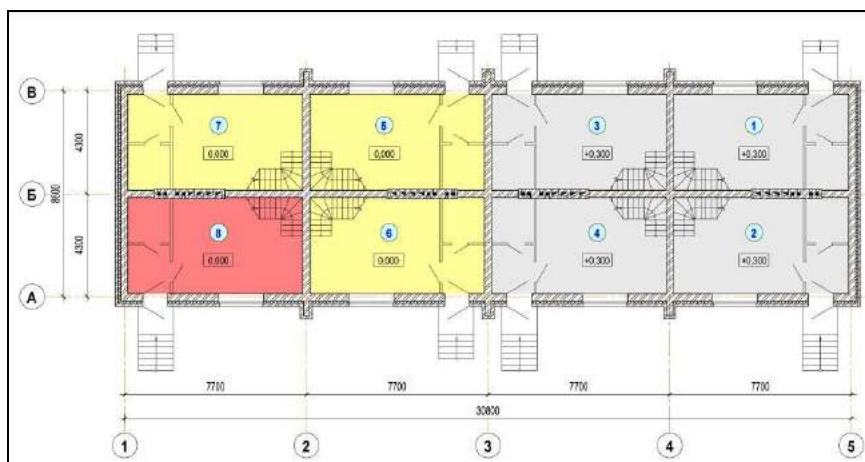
План 1-го этажа здания. Часть здания на участке в координационных осях «А-Б»/«1-2» испытывает наибольшие неравномерные деформации с образованием трещин в строительных конструкциях.
